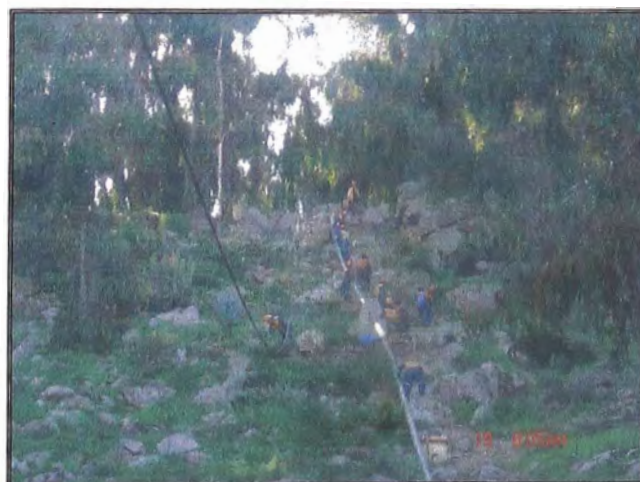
Vaciado de bajada Tramo Dos
